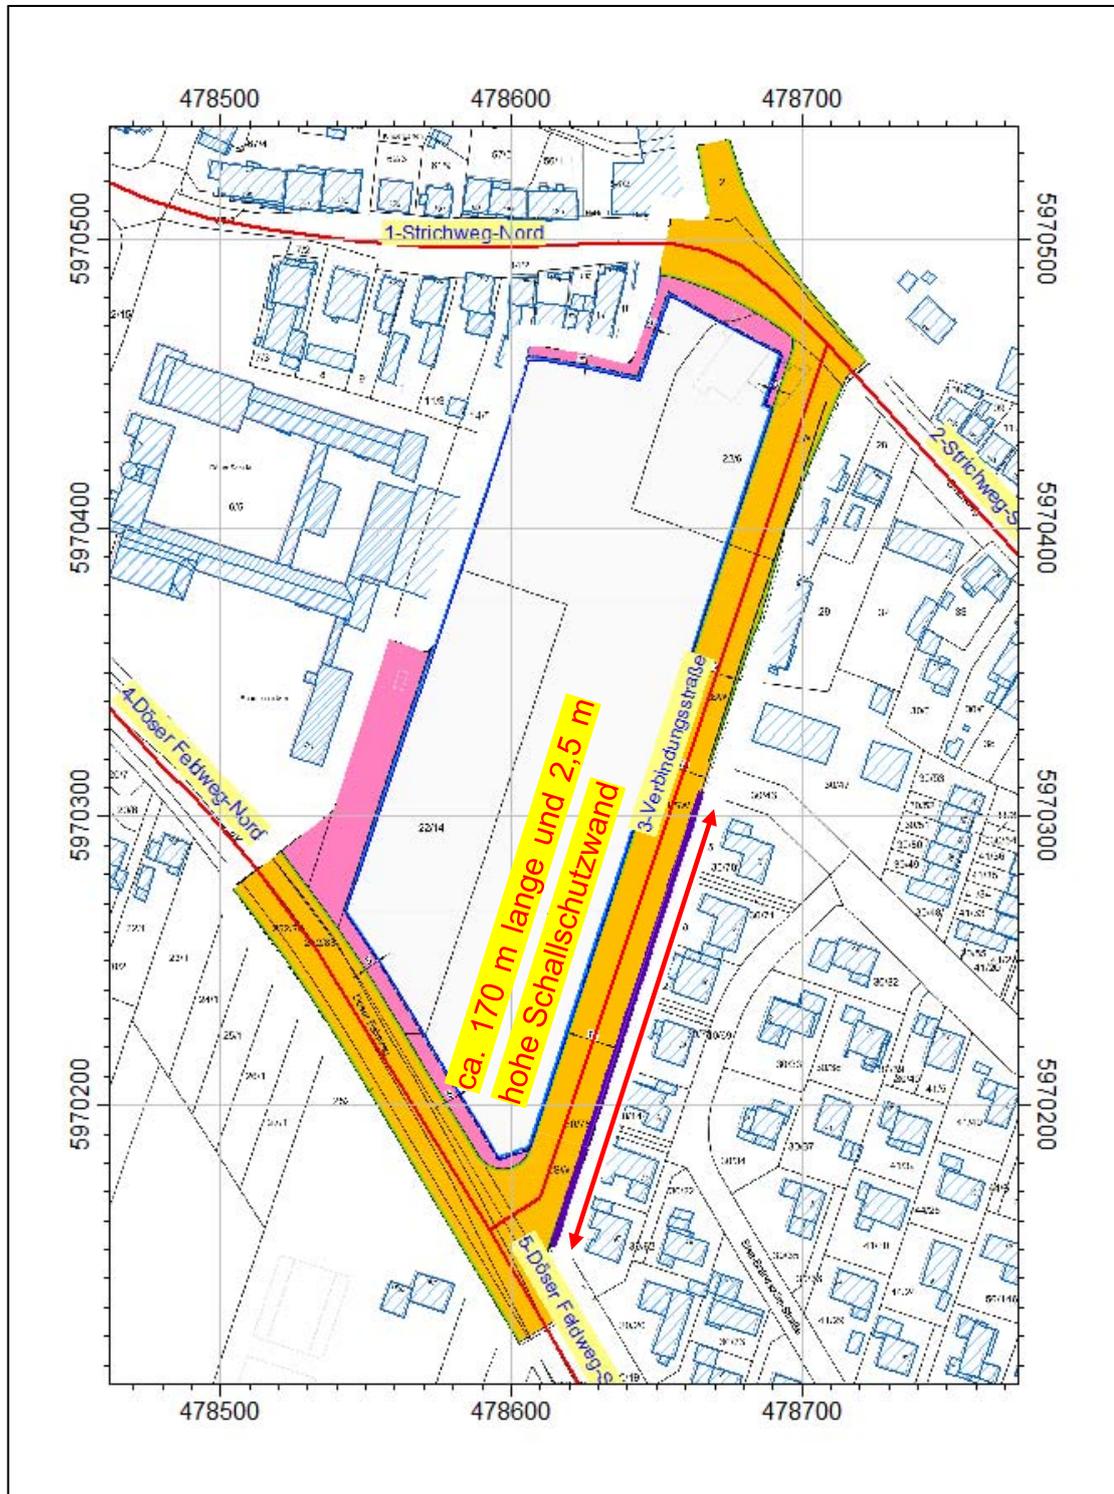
Lageplan mit Darstellung der Schallschutzwand
